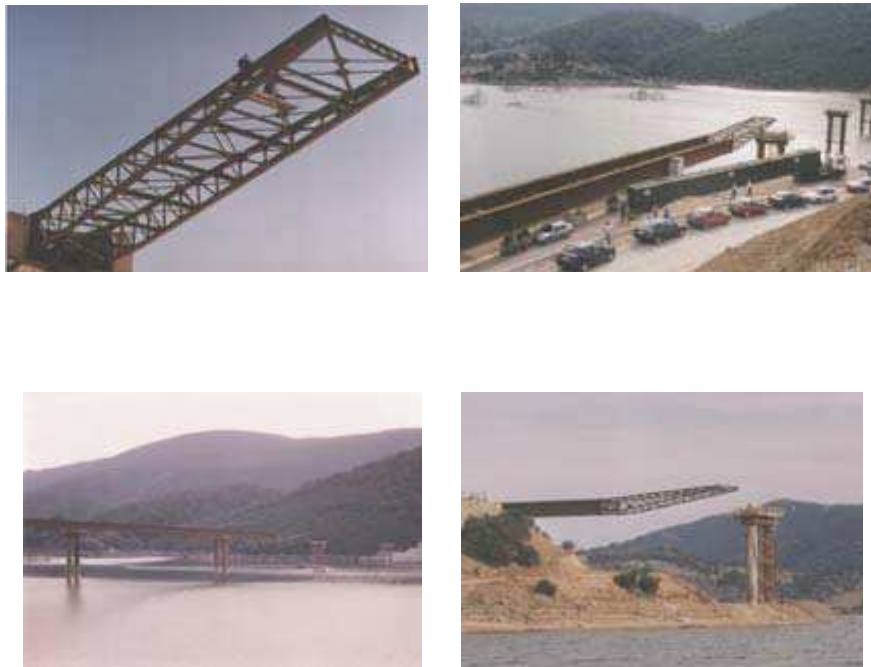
Conjunto estructural (par de vigas – nariz)
